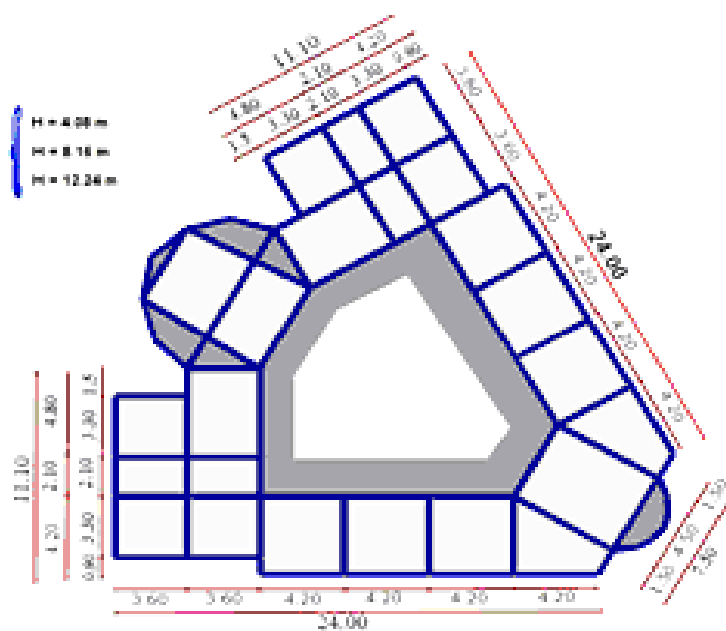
Vue en plan 2D, le plancher de RDC, 1^{er}, 2^{eme} étage
